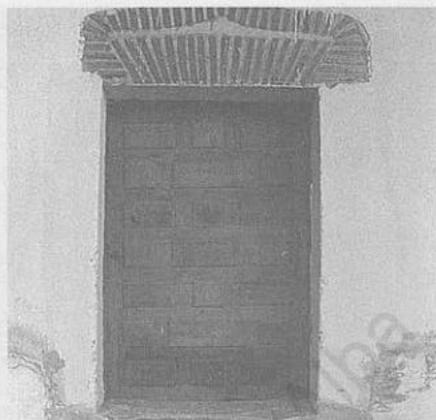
Claustro de los Reyes. Panda norte. Corredor inferior. Muro norte-lado sur. Puerta nº 9.
